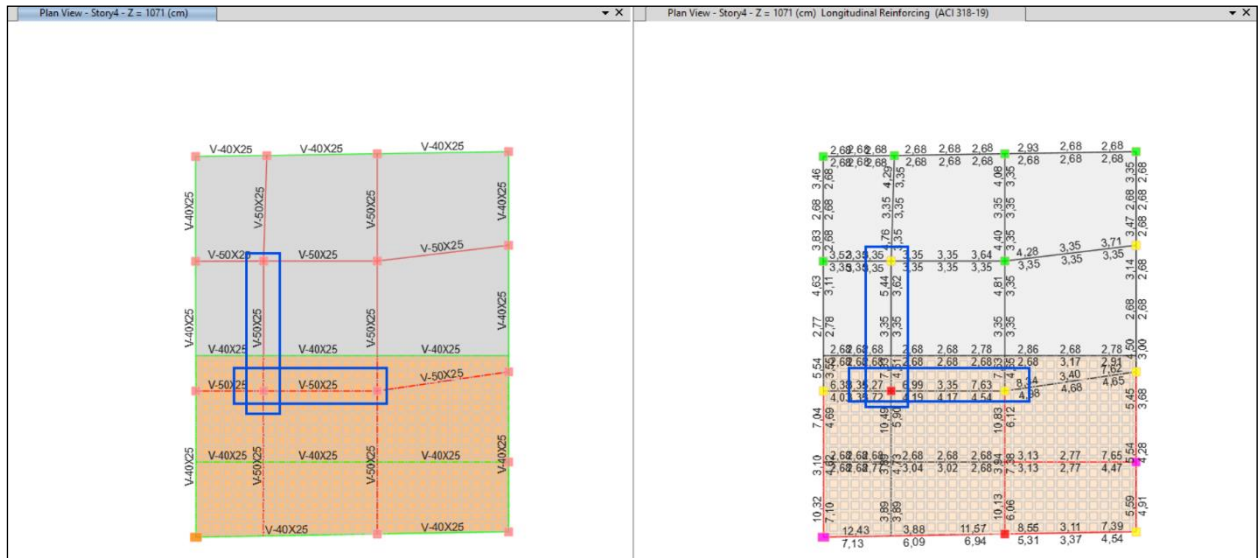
Acero a flexion en vigas de losa nivel 4, alternativa 1 [Autor]
